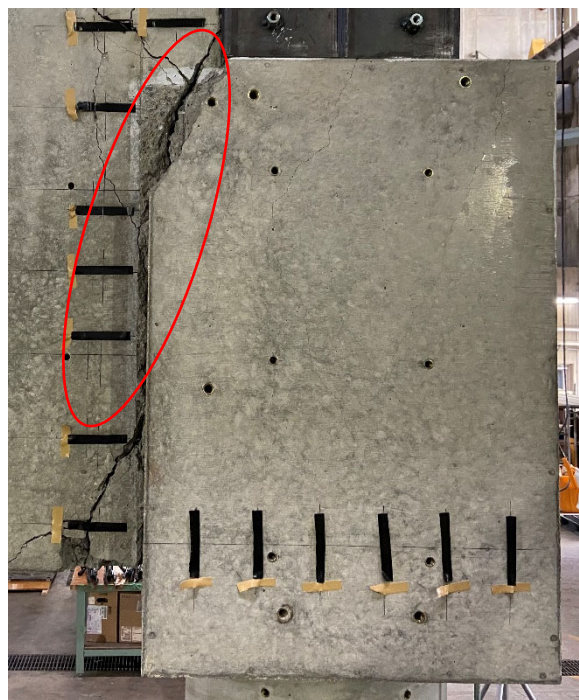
4. 9-2 試験体 E-2 裏面せん断ひび割れ
